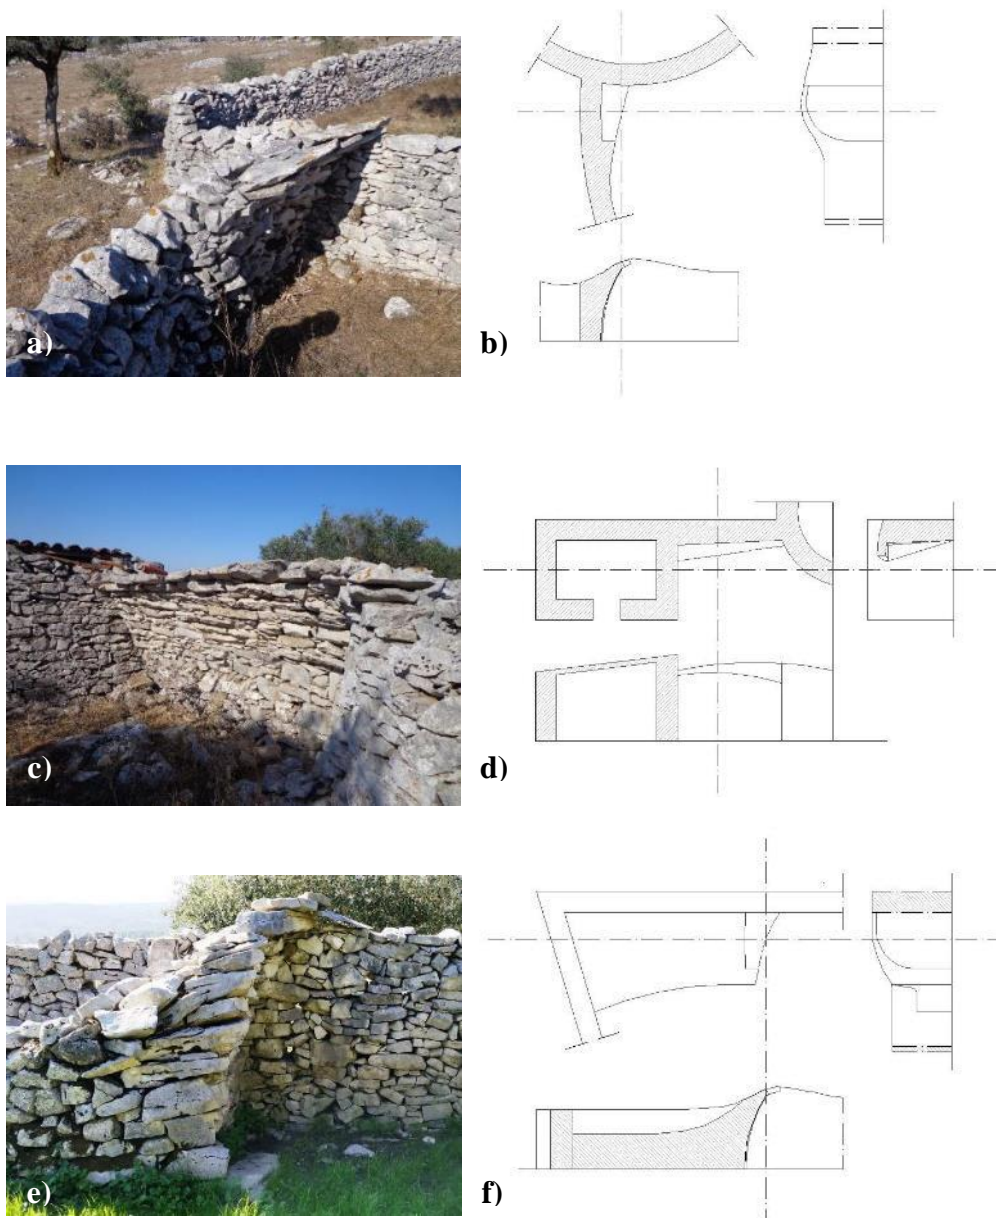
Abrigos de pastor: a) Utilização do muro lateral para apoio da cobertura; b) Tipologia de a) - Planta/Alçado corte; c) Utilização de parede de casina para apoio da cobertura; d) Tipologia de c) - Planta/Alçado/Corte; e) Utilização de muro lateral para apoio da cobertura; f) Tipologia de e) – Planta/Alçado/Corte
